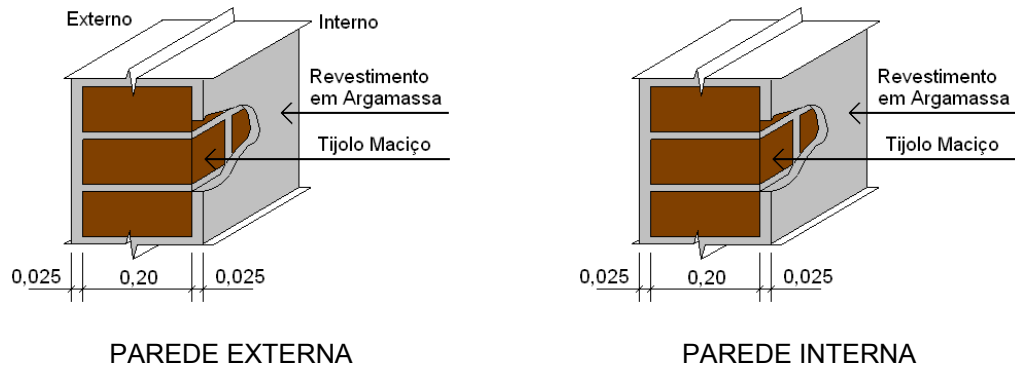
Detalhe construtivo das alvenarias externa e interna - Edificação 7.
